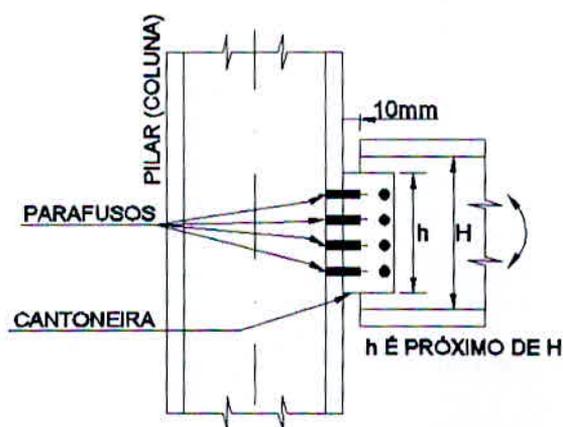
Ligação semi-rígida viga coluna com cantoneira. Fonte: Autor.
